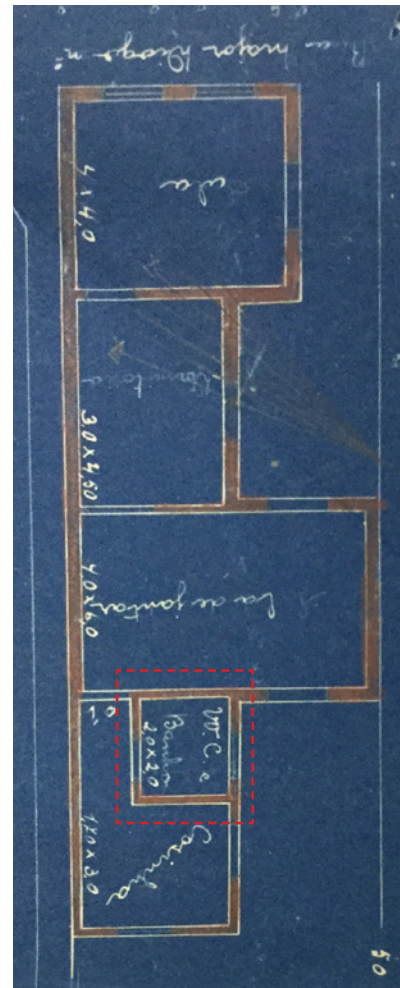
e 3.27 Plantas com banheiros tipo “B” e “C” em bairros em processo de consolidação da infraestrutura.
